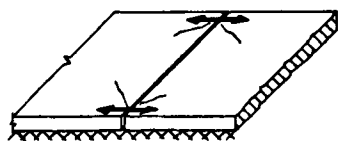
Grietas producidas por expansión del pavimento y mal funcionamiento de la junta.
